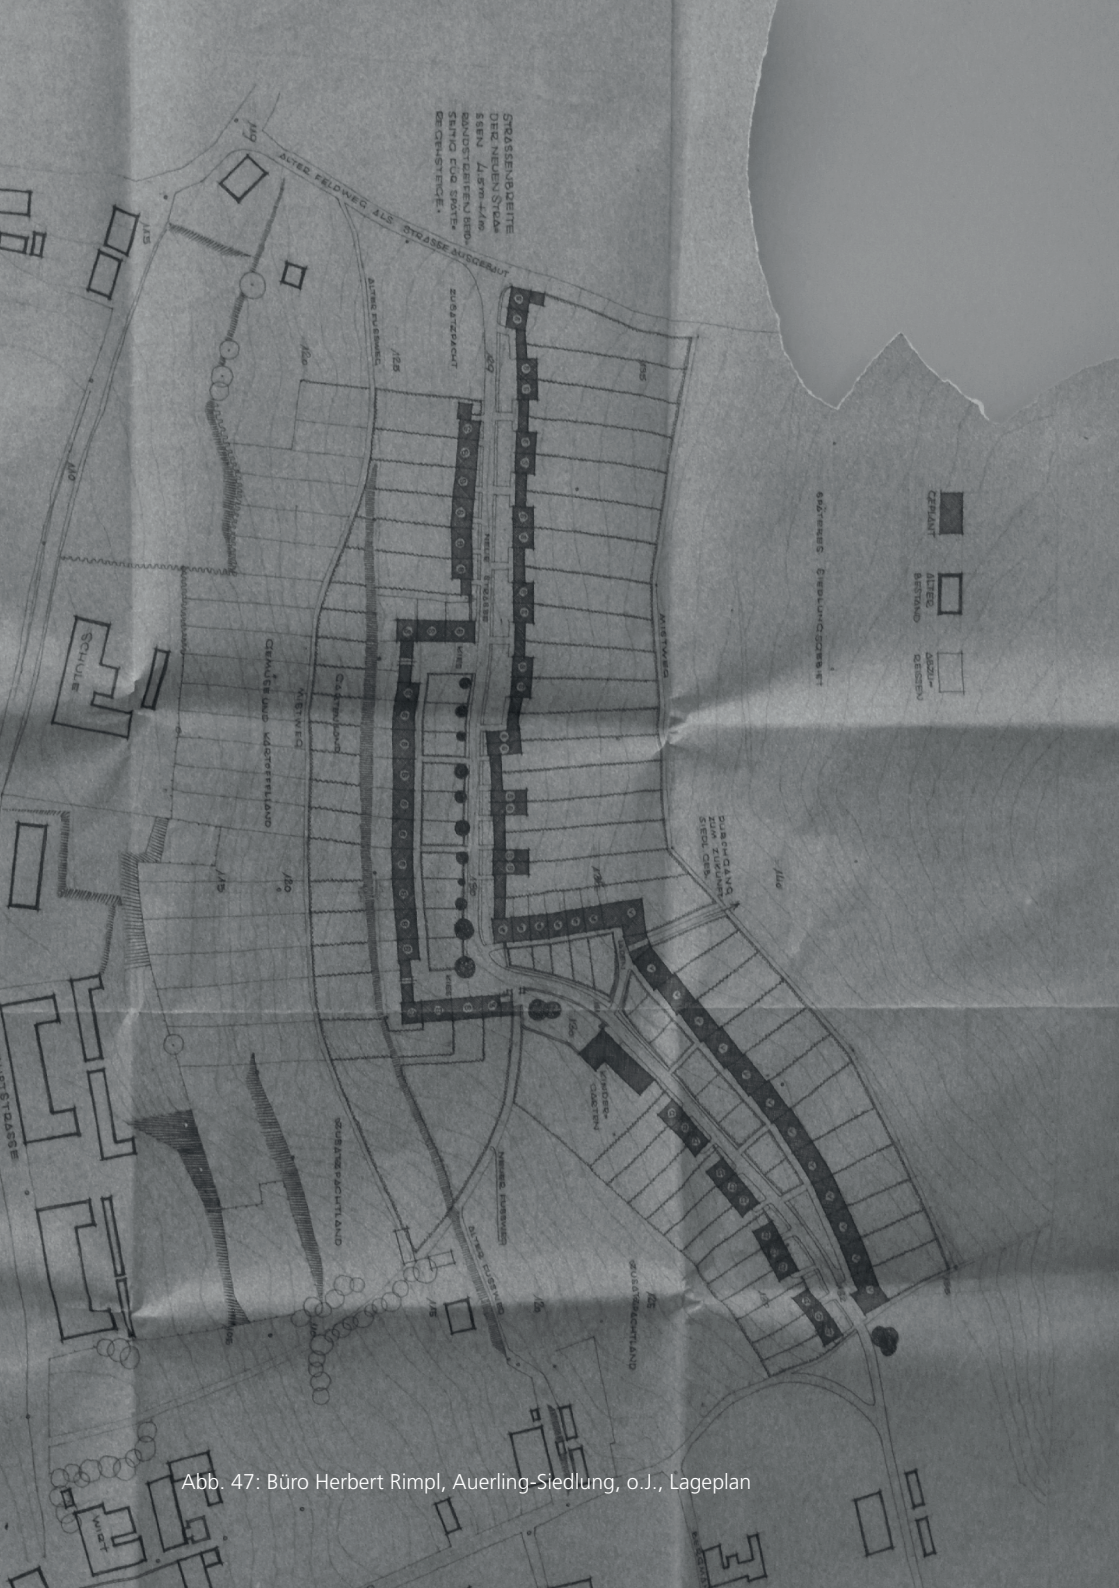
Büro Herbert Rimpl, Auerling-Siedlung, o.J., Lageplan
